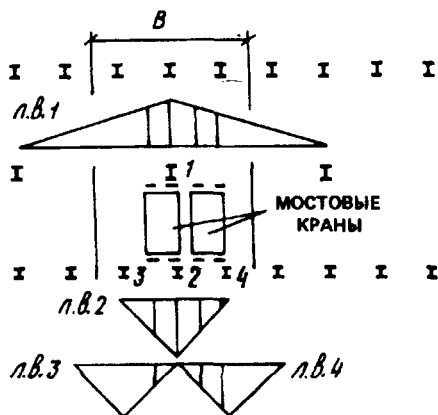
К определению нагрузок от мостовых кранов в многопролетных цехах
